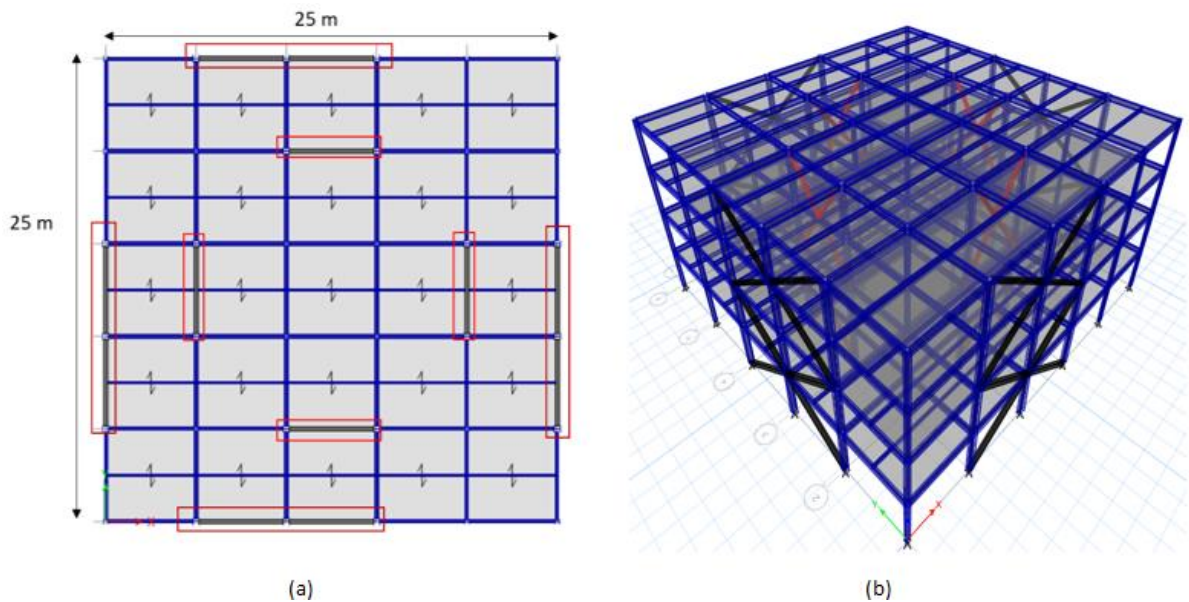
6: (a) Vista en planta y (b) Vista en 3D. Estructuras de 4 pisos.
